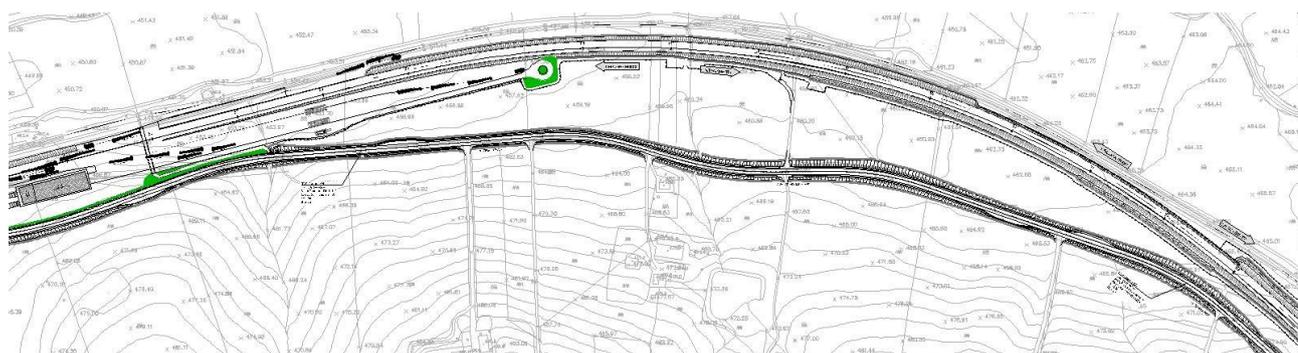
NV01 stralcio planimetrico da km 3+450 a km 4+700
